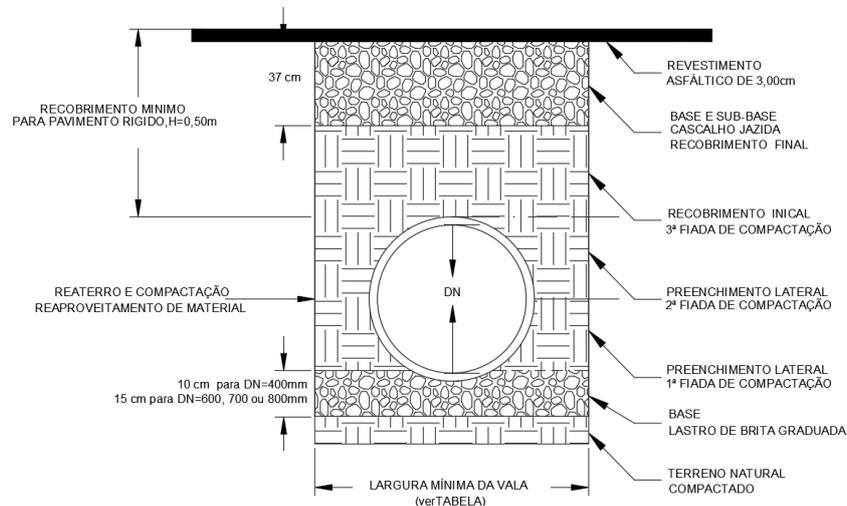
Corte Transversal dos Tubos de Concreto com definição das etapas de assentamento.
